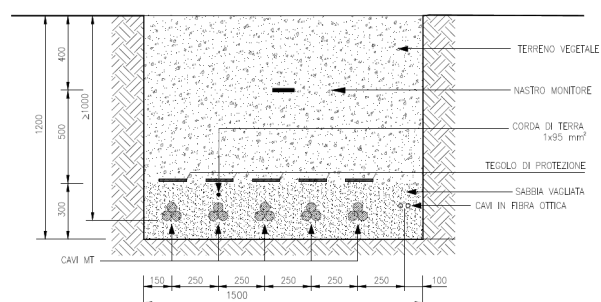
Sezioni di posa cavidotti in terreno vegetale
